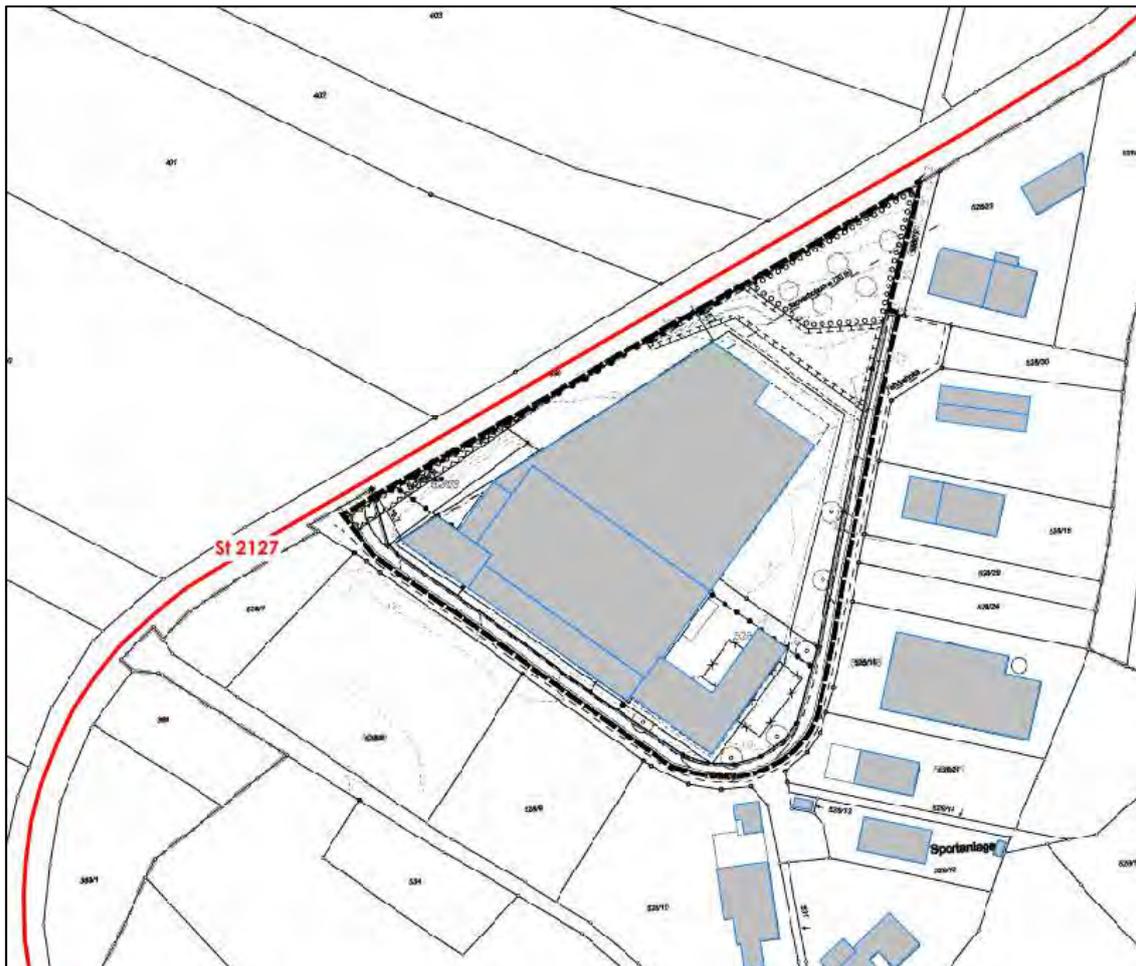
Lageplan mit Darstellung der relevanten Straße
